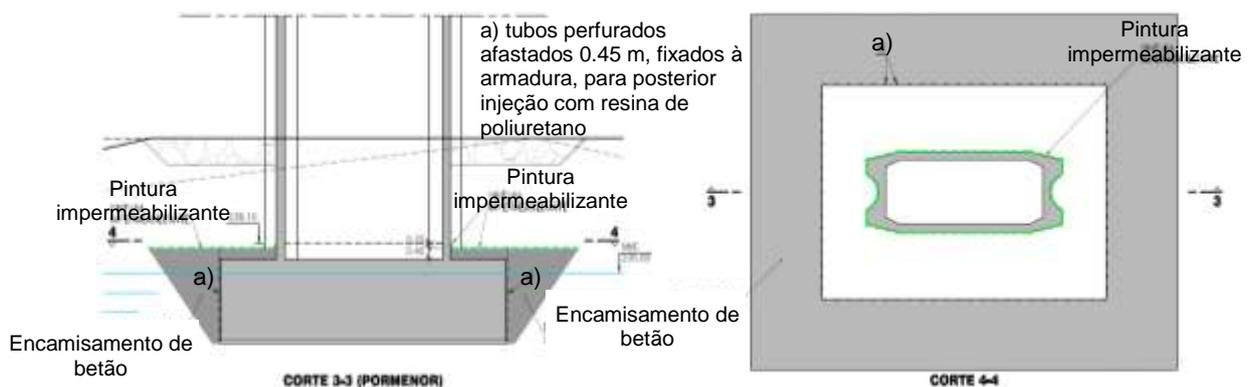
Ponte s/ o Rio Sabor – Pormenor de Execução
